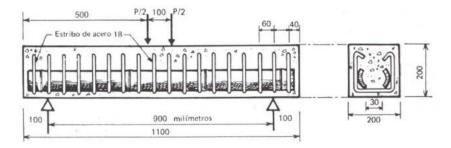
Viga (4) de hormigón reforzada con bambú. Fuente González Salcedo, 2001
